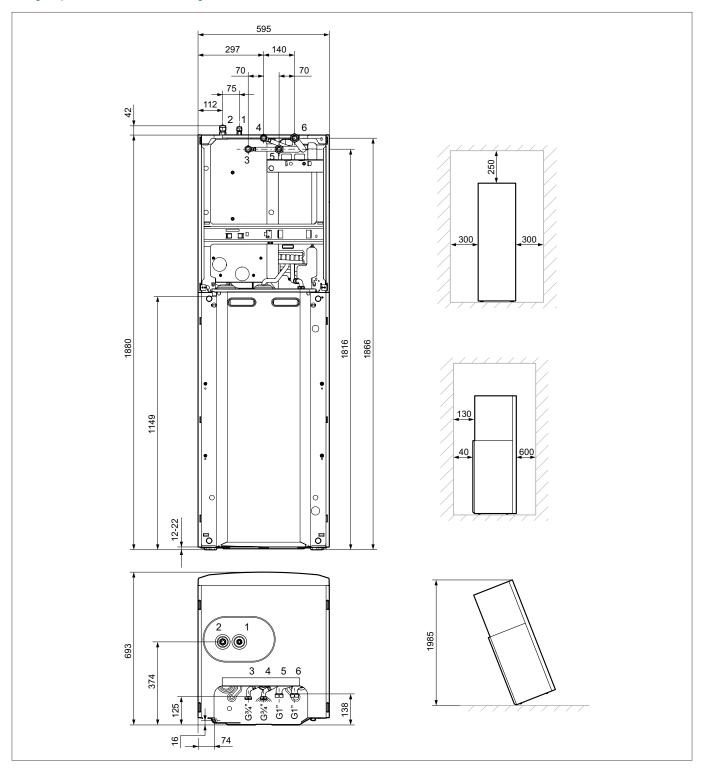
Disegno quotato e dimensioni collegamenti uniTOWER VIH QW 190/1 E
